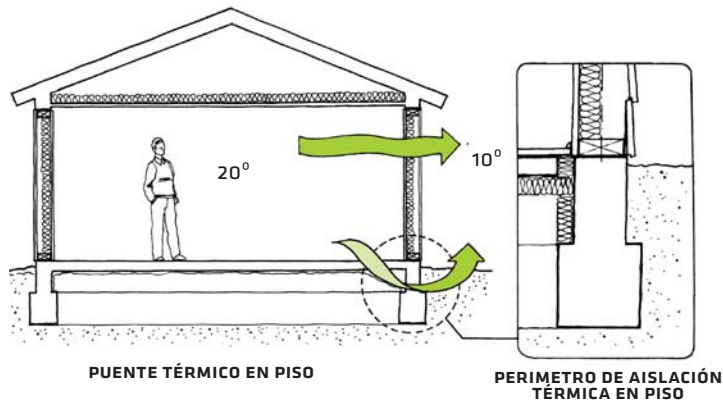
Puente térmico o pérdida perimetral de calor en piso sobre terreno. Se repara con instalación de aislación térmica en el perímetro del piso.
